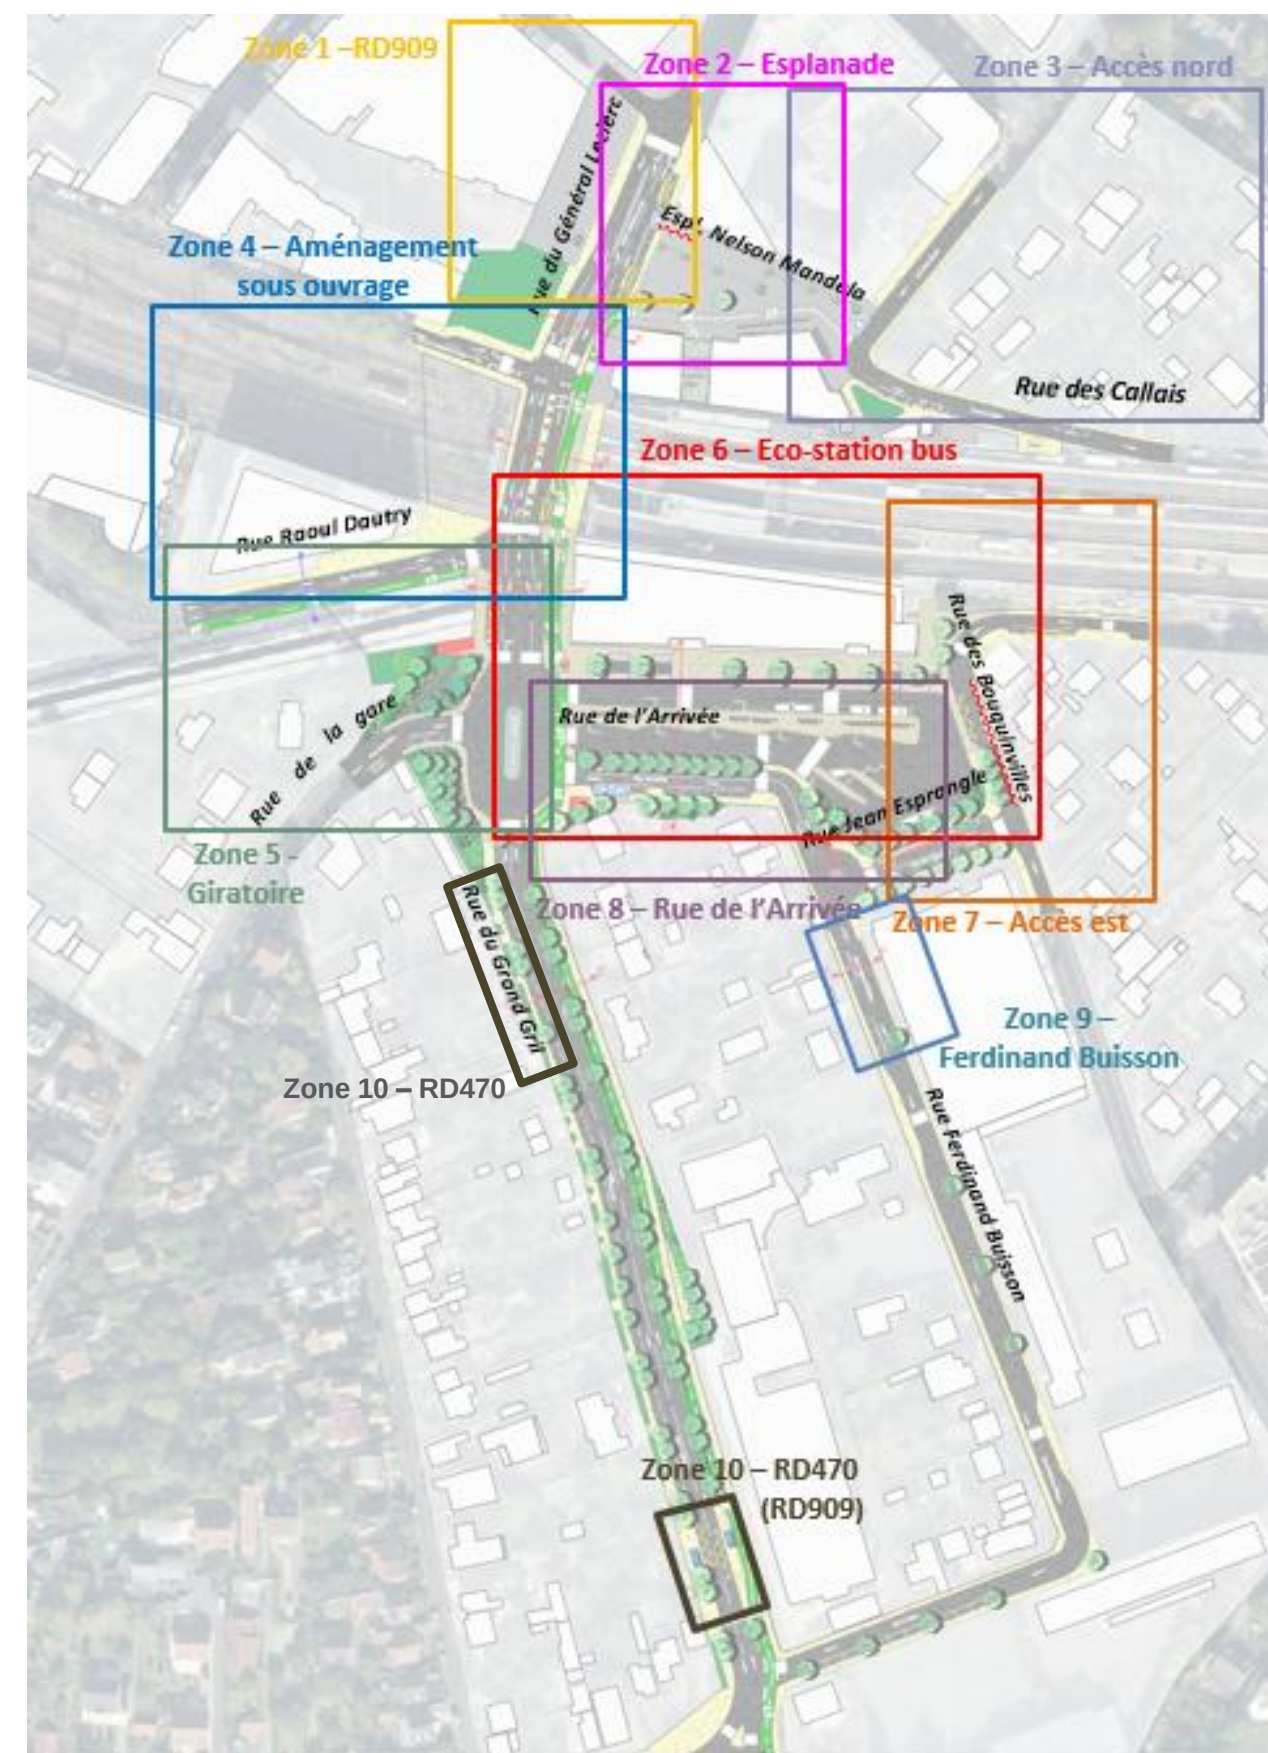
Plan général du projet d'aménagement ; Source : Ingérop, 2024
